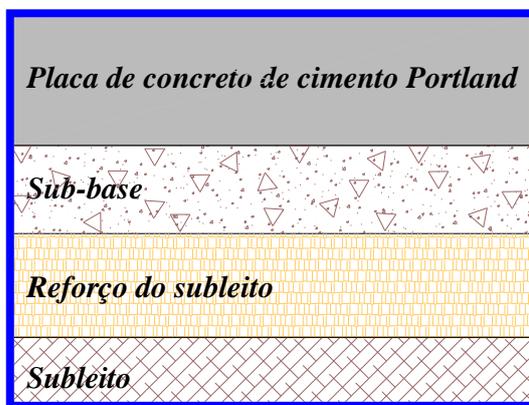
(a): seção esquemática de um pavimento de concreto de cimento Portland
